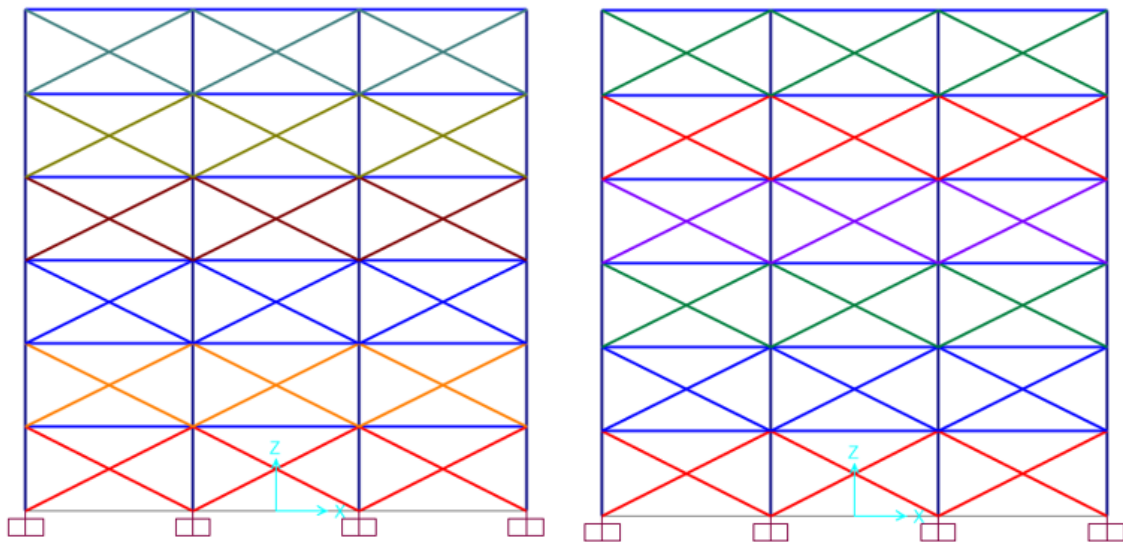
Vista en elevación de los pórticos paralelos al eje X centrales (izquierda) y en el perímetro (derecha) con sus respectivos puntales a compresión en SAP2000.
